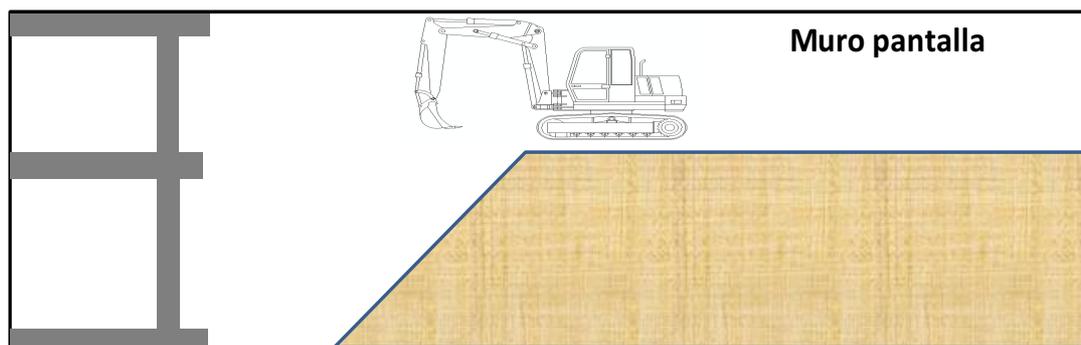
Vaciado siguiente tramo concluida la estructura
